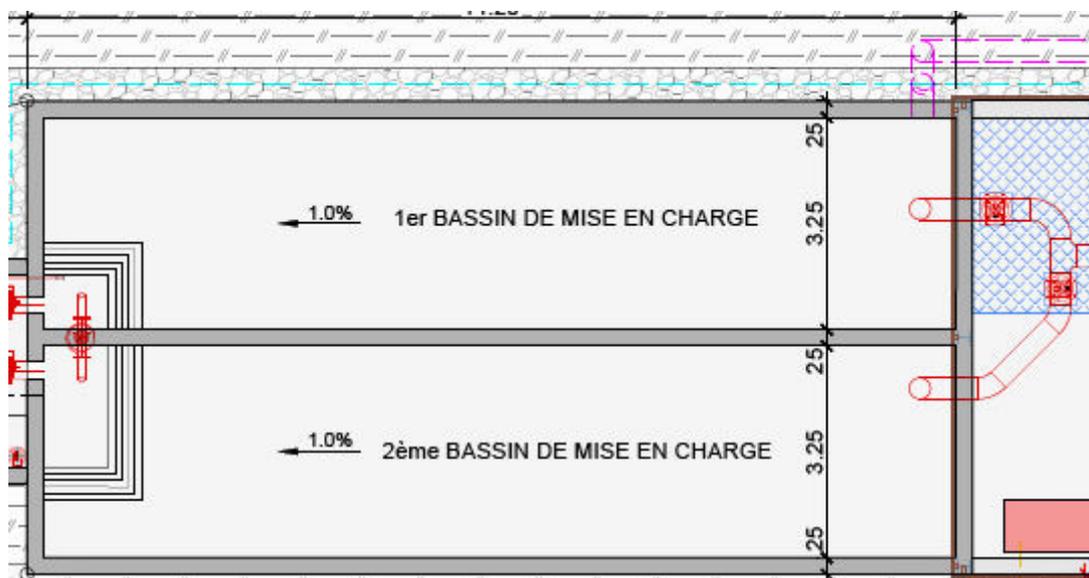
Extrait du plan de dispositions générales – bassins, vue en situation
